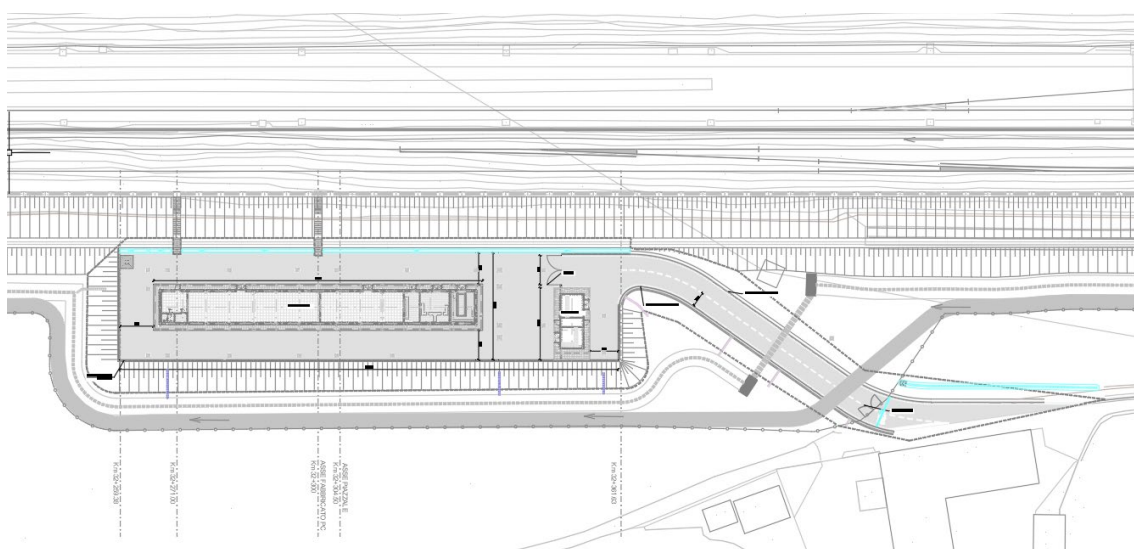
Estratto planimetrico dello stato di progetto – Individuazione dell'area oggetto di intervento con polilinea tratteggiata nera.
